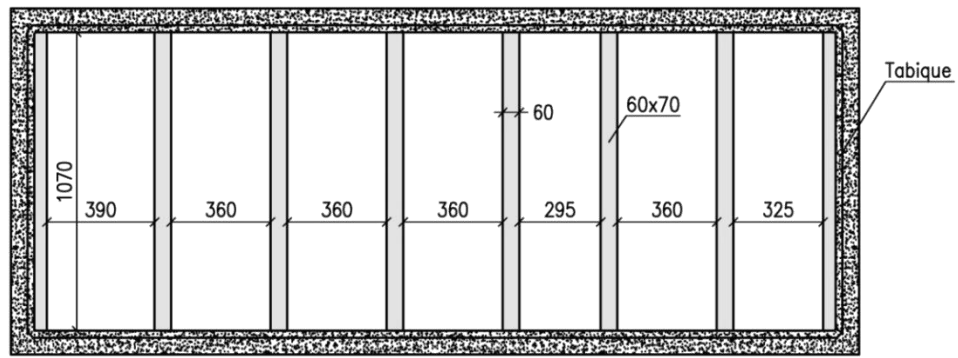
Vista en Planta – Arriostramientos de las pantallas en nivel superior
